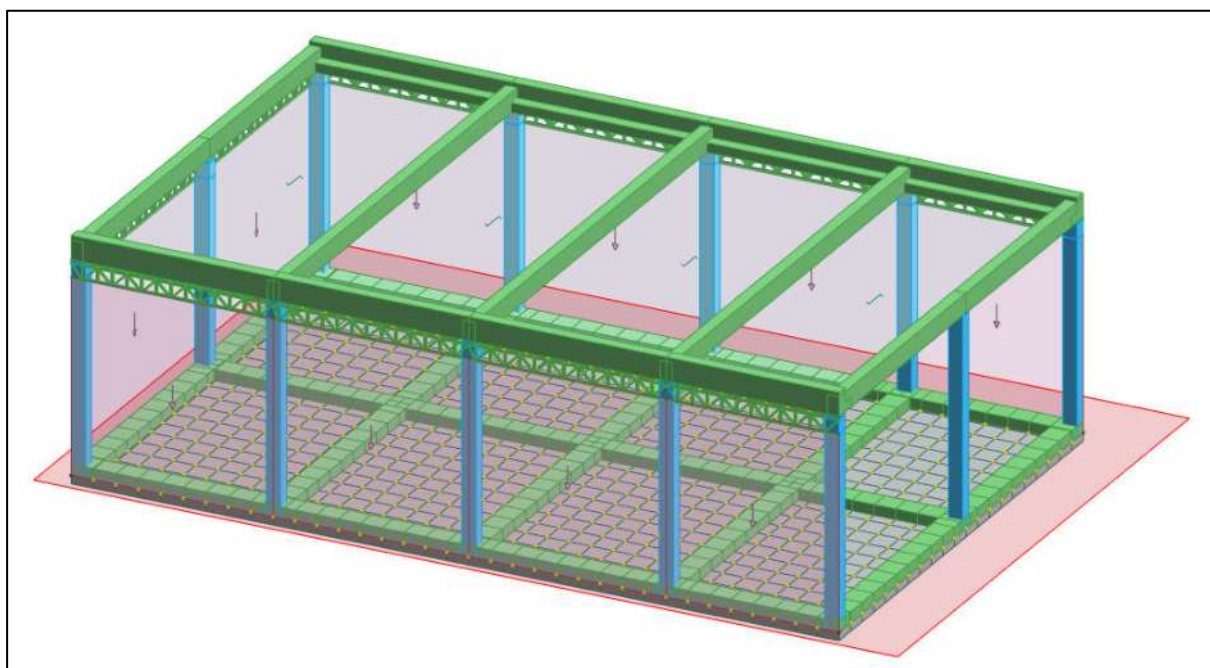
Vista 3D ModeSt ver. 8.25 palestra
